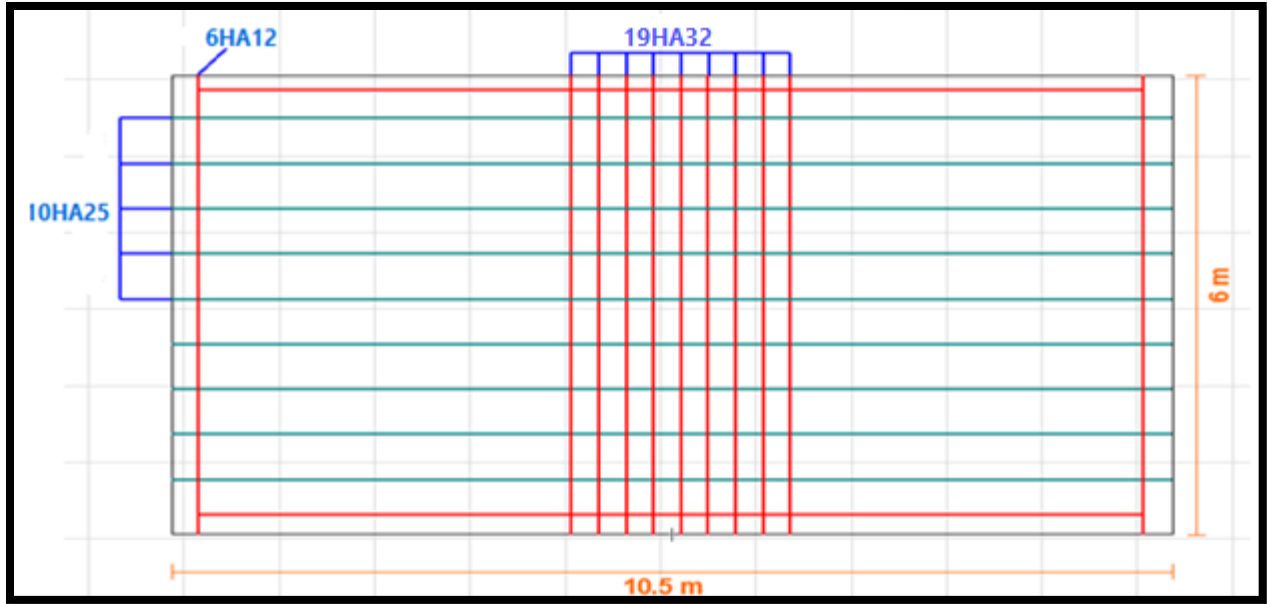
Ferrailage de la semelle – nappe inférieure
